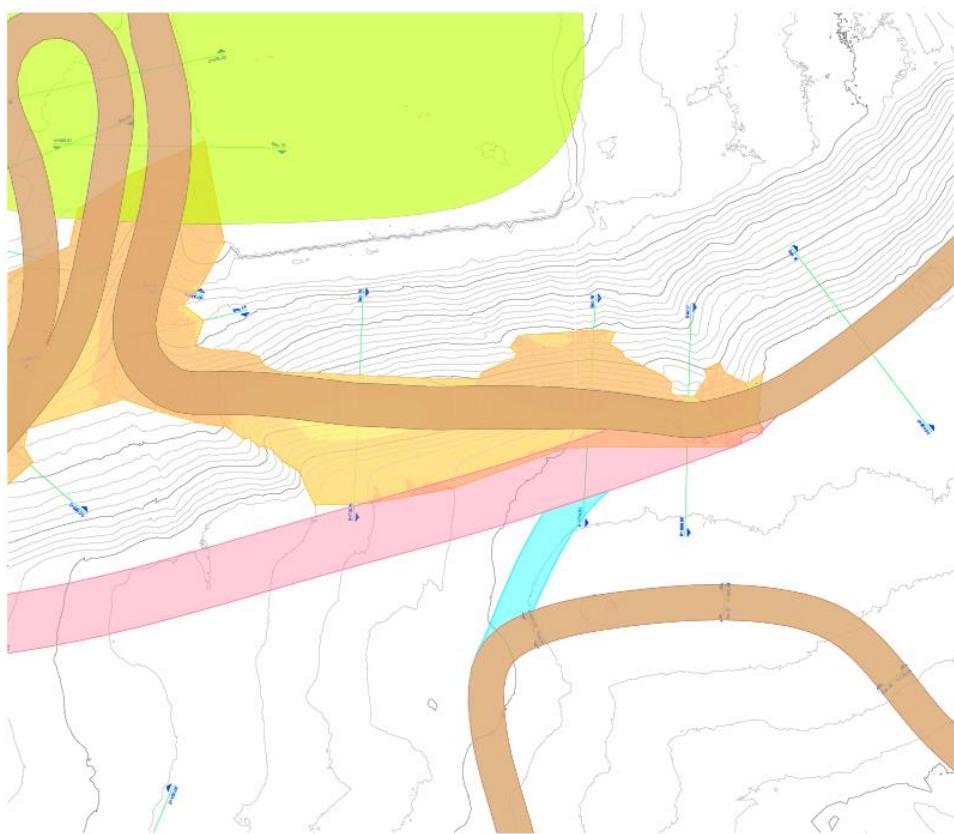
Estratto planimetria sterri e riporti - scala a vista
